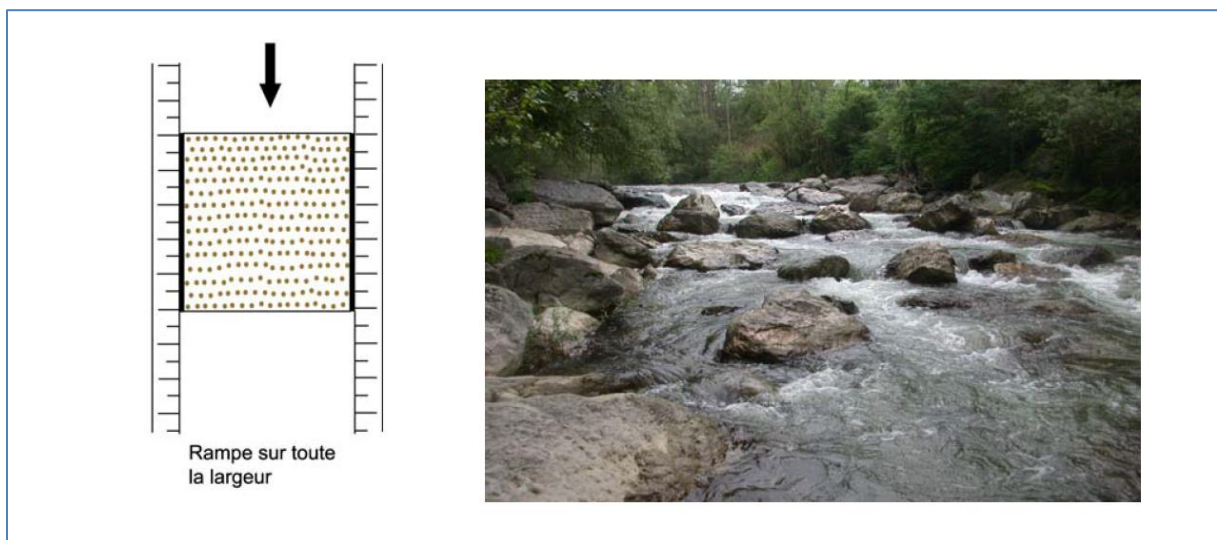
Schéma d'une rivière et de rampe sur toute la largeur du lit
